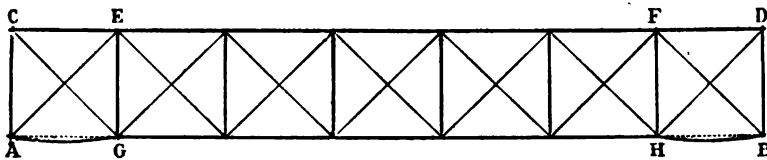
Effets d'un Serrage exagéré du Contreventement.
